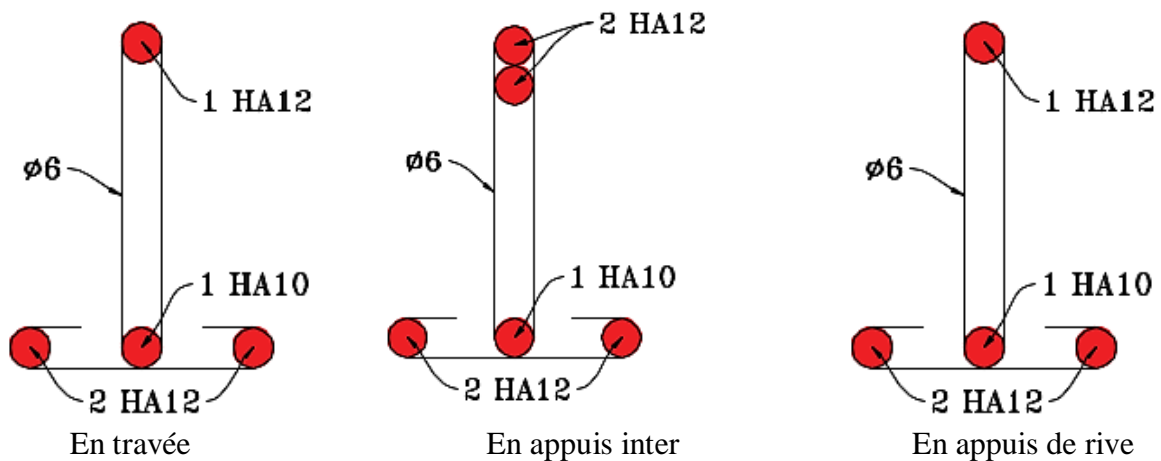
Schémas de ferrillage des poutrelles étage courant +RDC.
